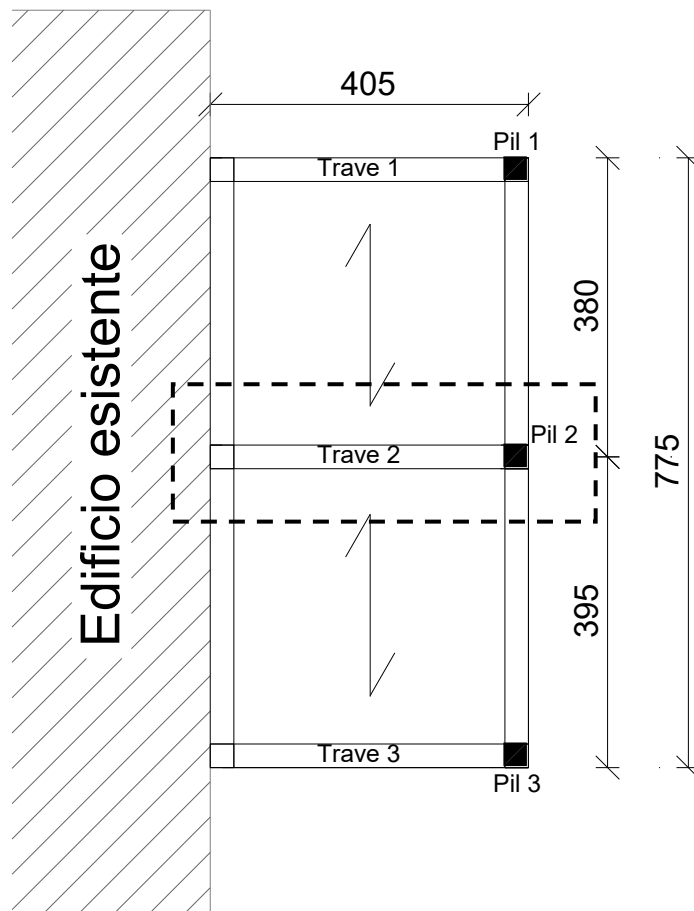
Pianta della struttura con evidenziato il telaio centrale
